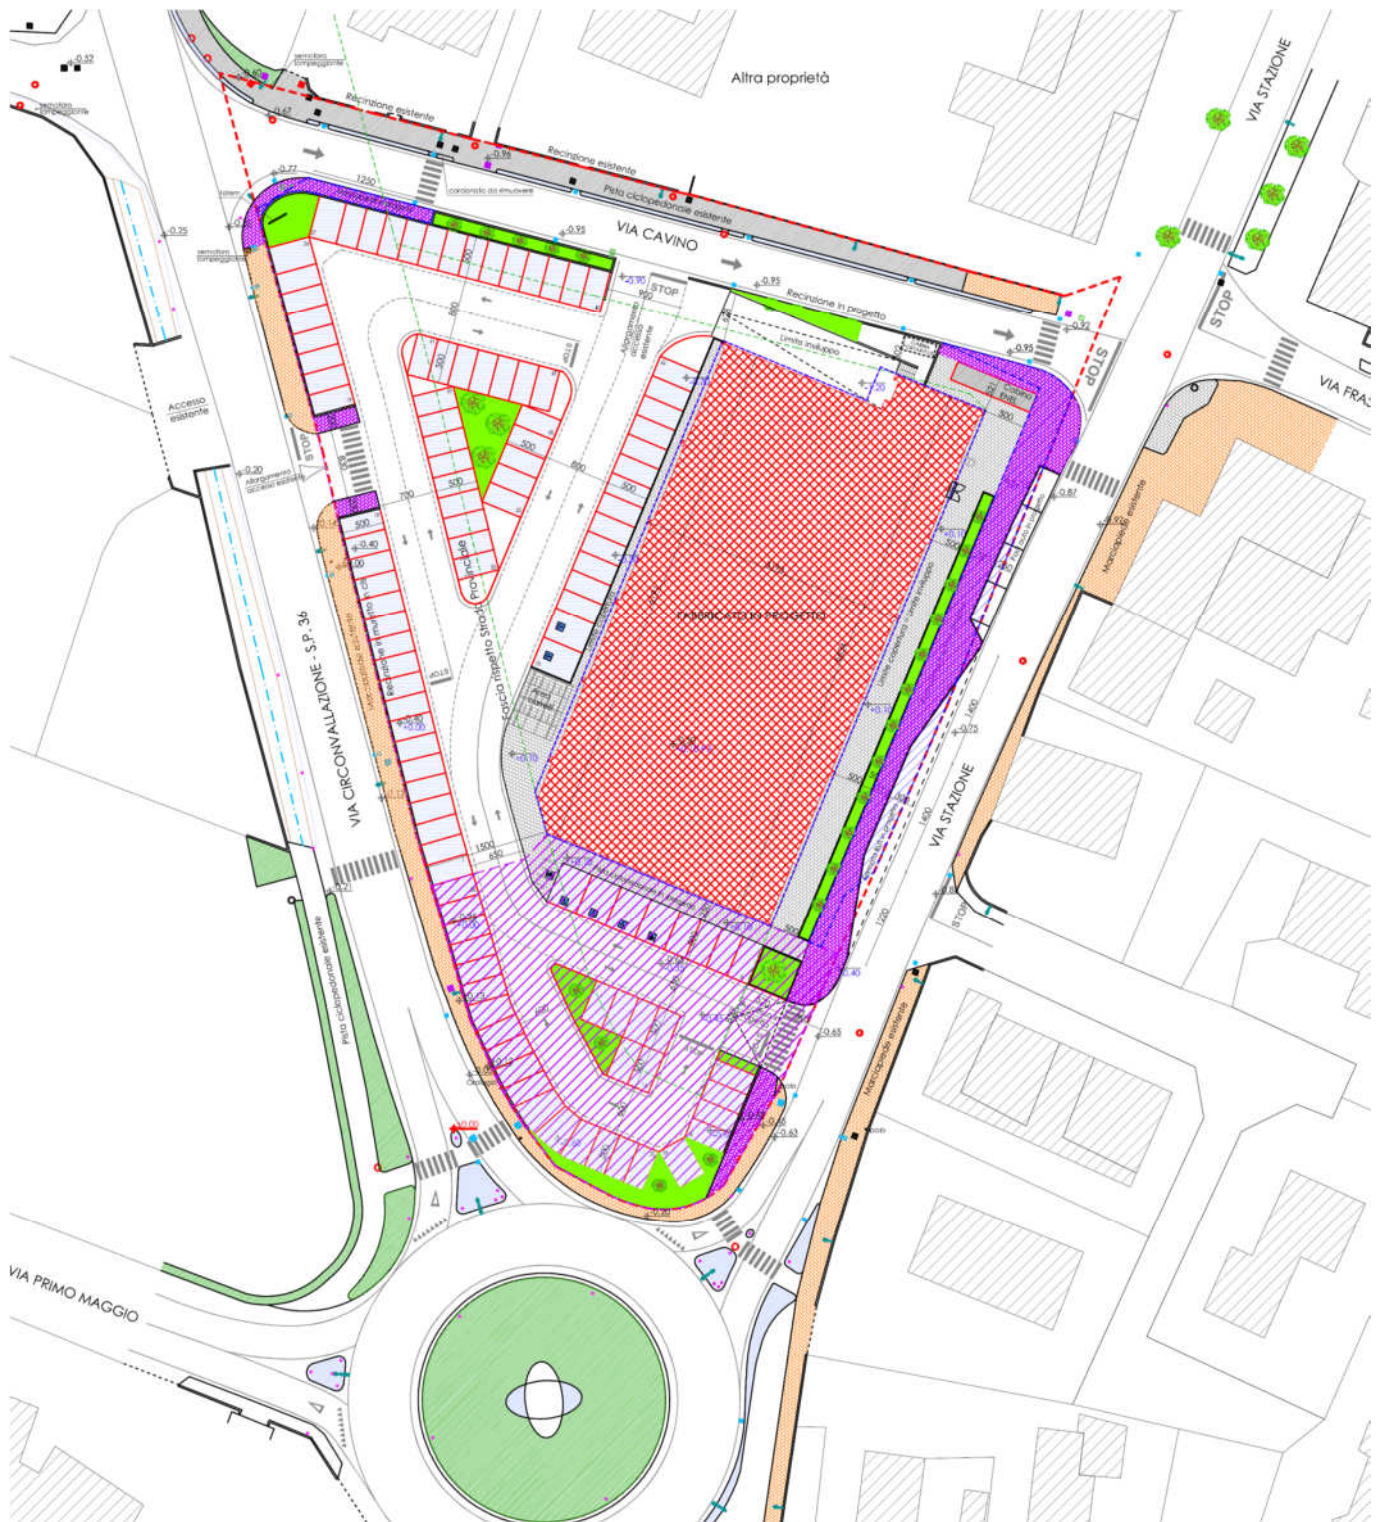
Planimetria stato di progetto ("Elaborato Architettonico" modificato)
